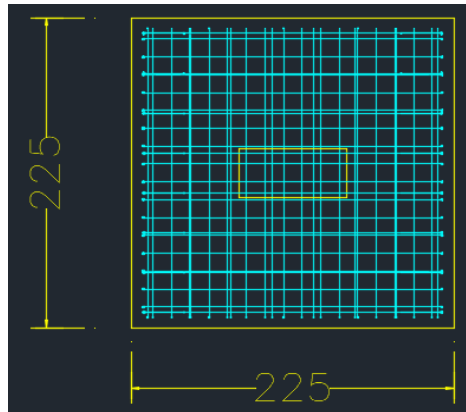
Distribución de aceros vigas de cimentación. Fuente: Planos estructurales.
